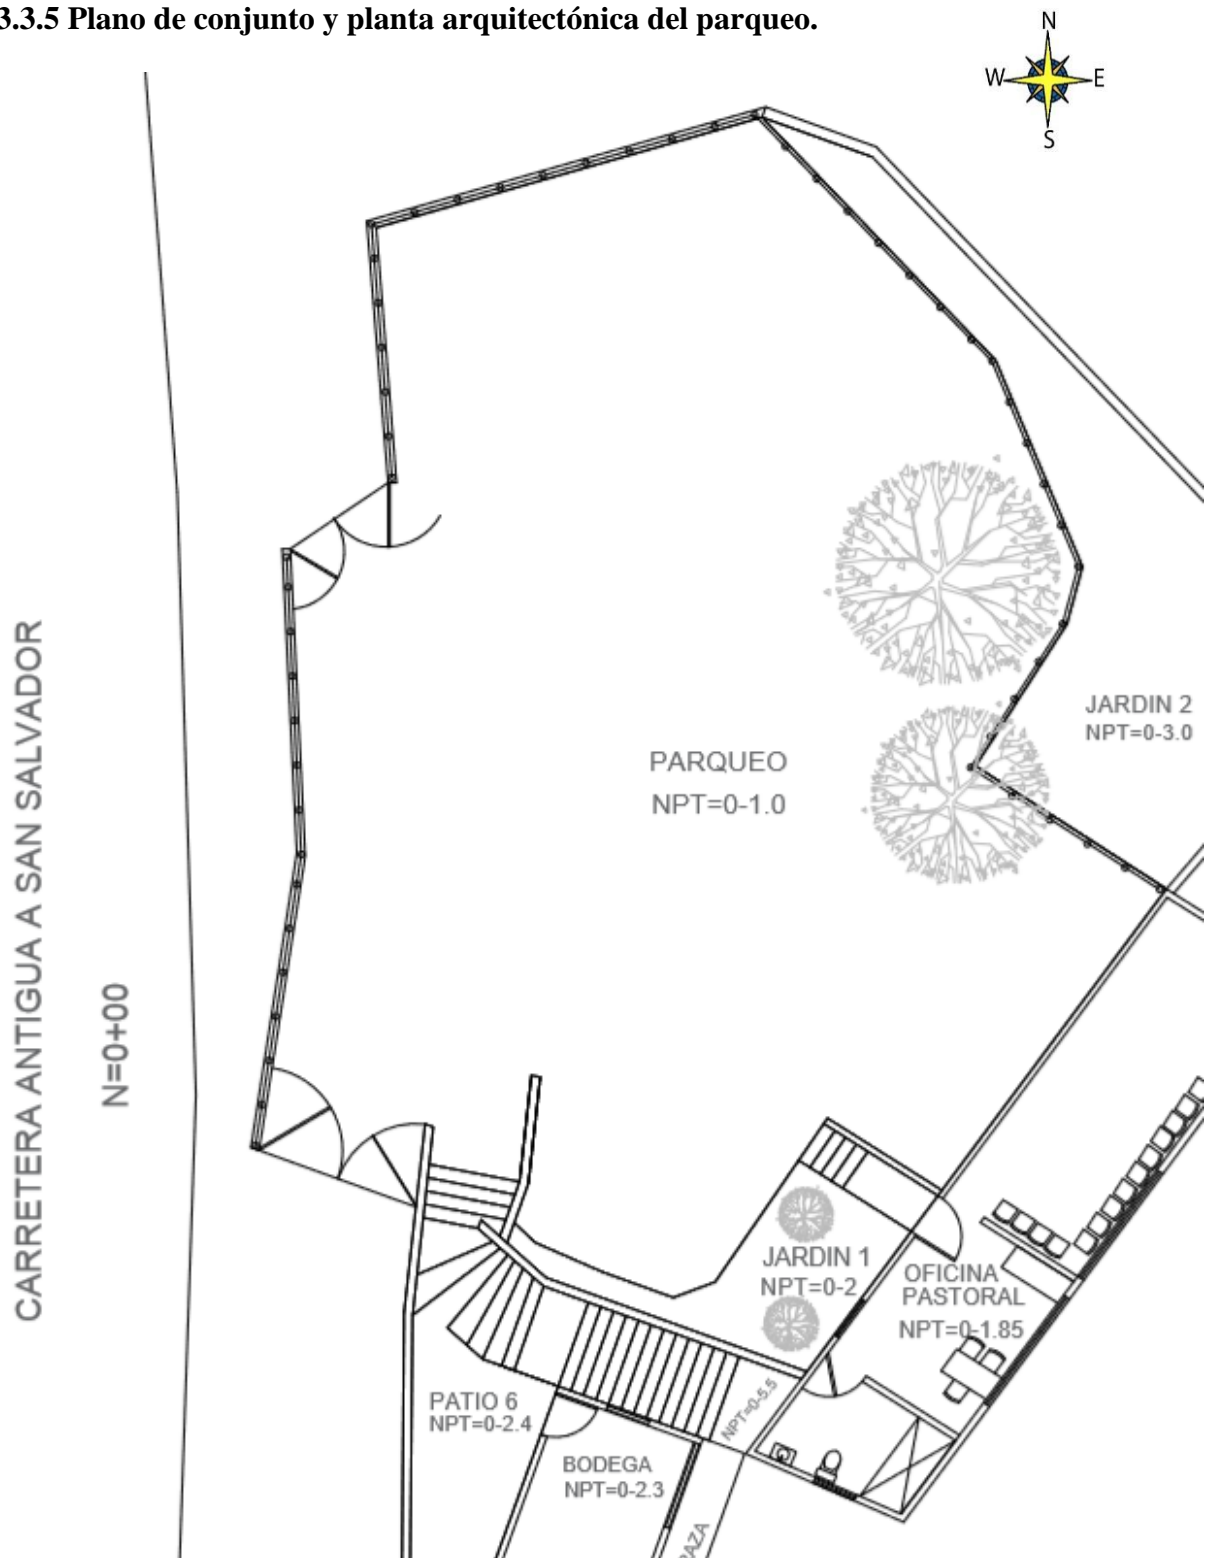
Plano de conjunto y planta arquitectónica del parque. Elaboración propia.
